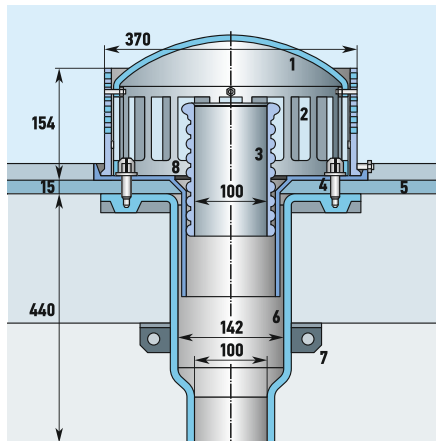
Водосточная воронка ВР-8 для плоских заполняемых водой кровель (1 — колпак; 2 — приёмная решётка; 3 — регулирующий патрубок; 4 — глухая гайка; 5 — прижимное кольцо; 6 — сливной патрубок; 7 — хомут)
